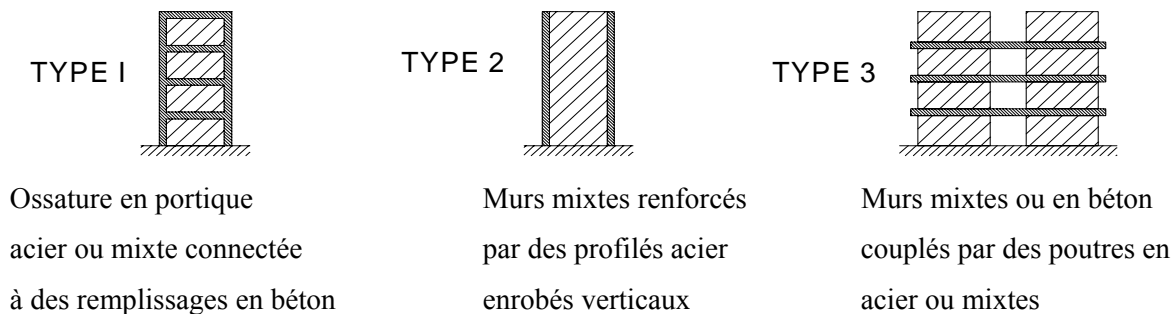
Murs mixtes (Type 1 et 2). Murs mixtes ou en béton armé couplés par des poutres aciers ou mixtes (Type 3).
